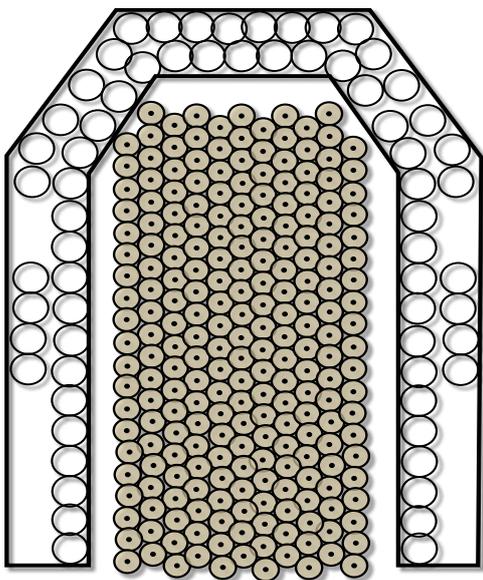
Schema della disposizione delle colonne Jet Grouting nella realizzazione delle fondazioni dirette.
